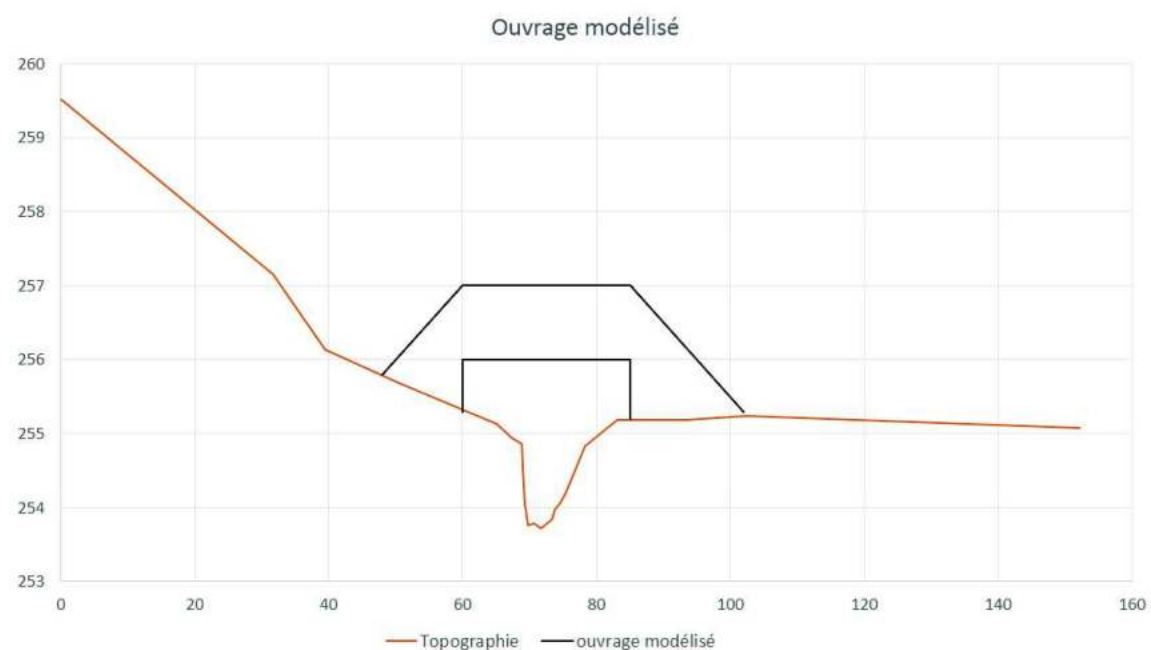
Profil de l'ouvrage de franchissement au niveau du profil 6 de pk 1707
